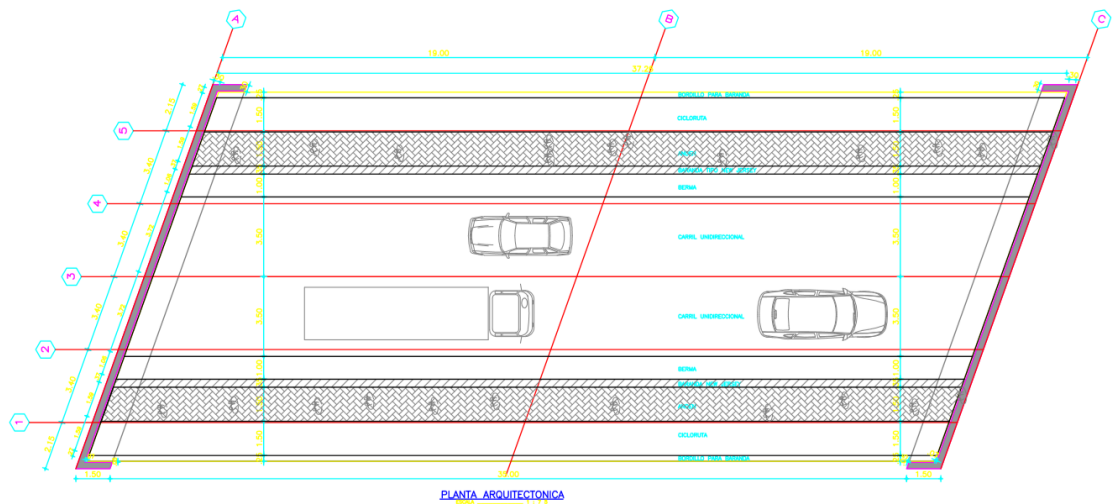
Plano perfil transversal puente sobre Rio Chicamocha del contrato 265/2019
